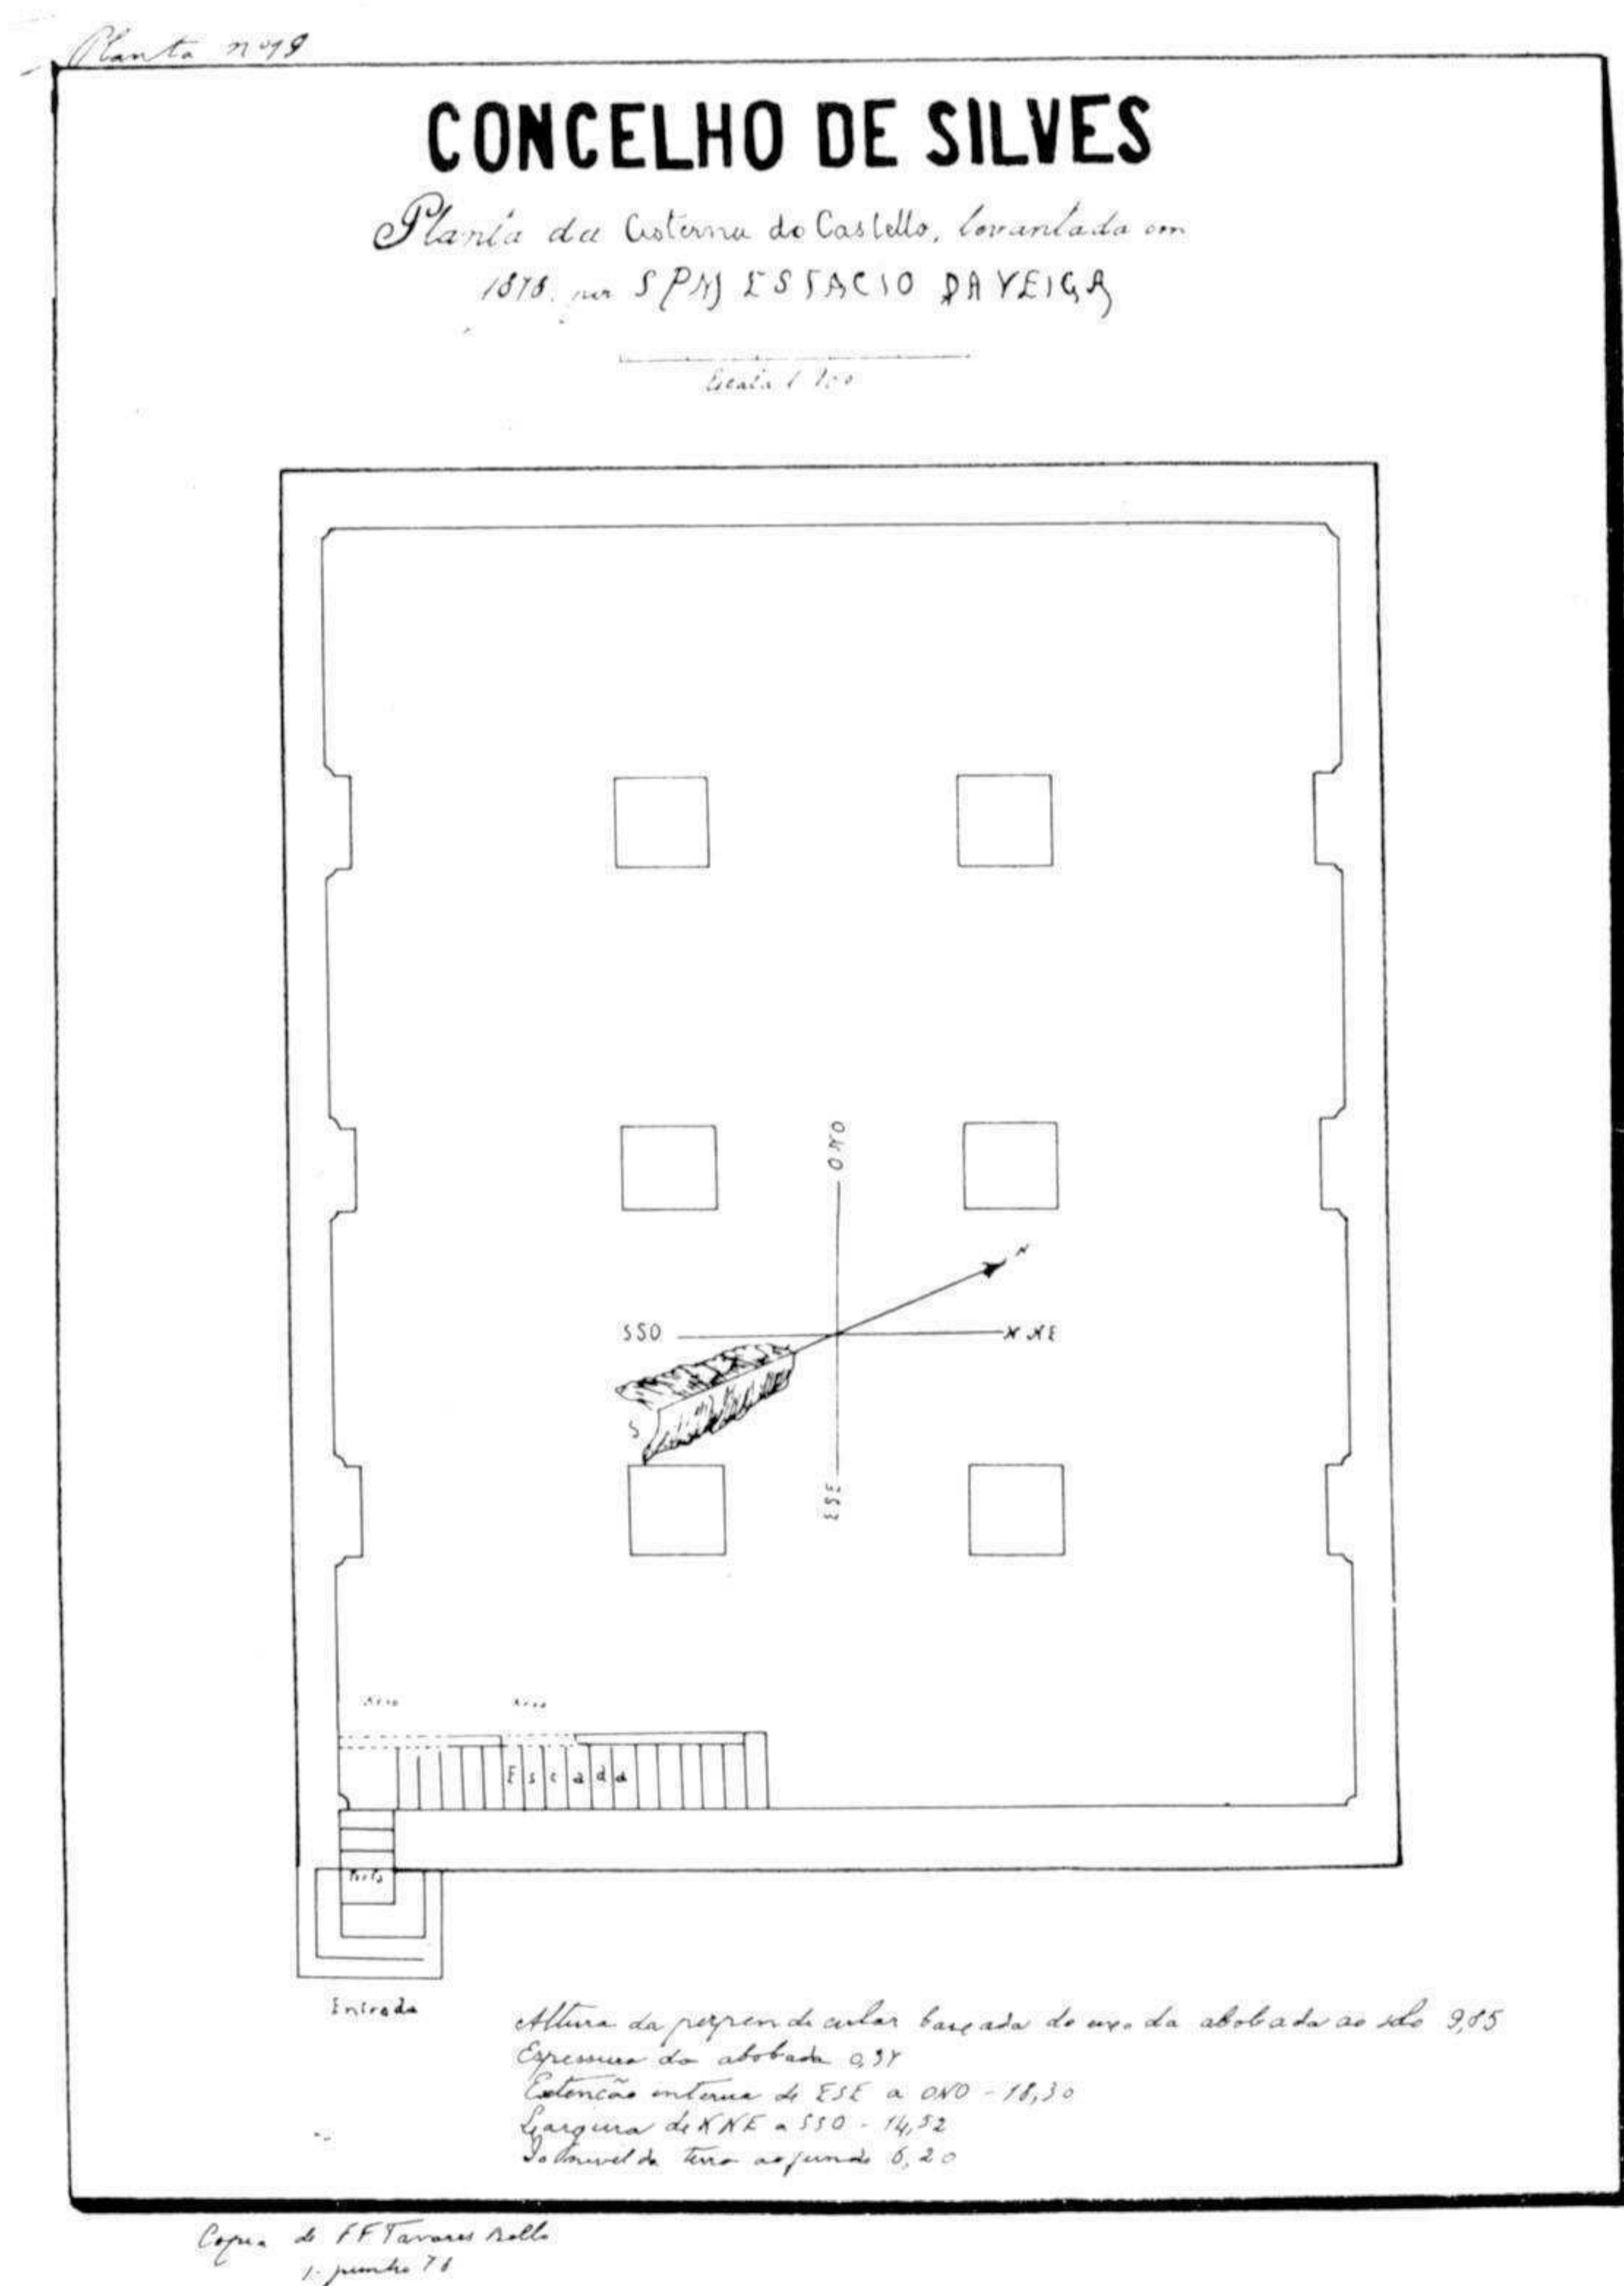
Planta do aljibe (seg. E. da Veiga, 1878).
